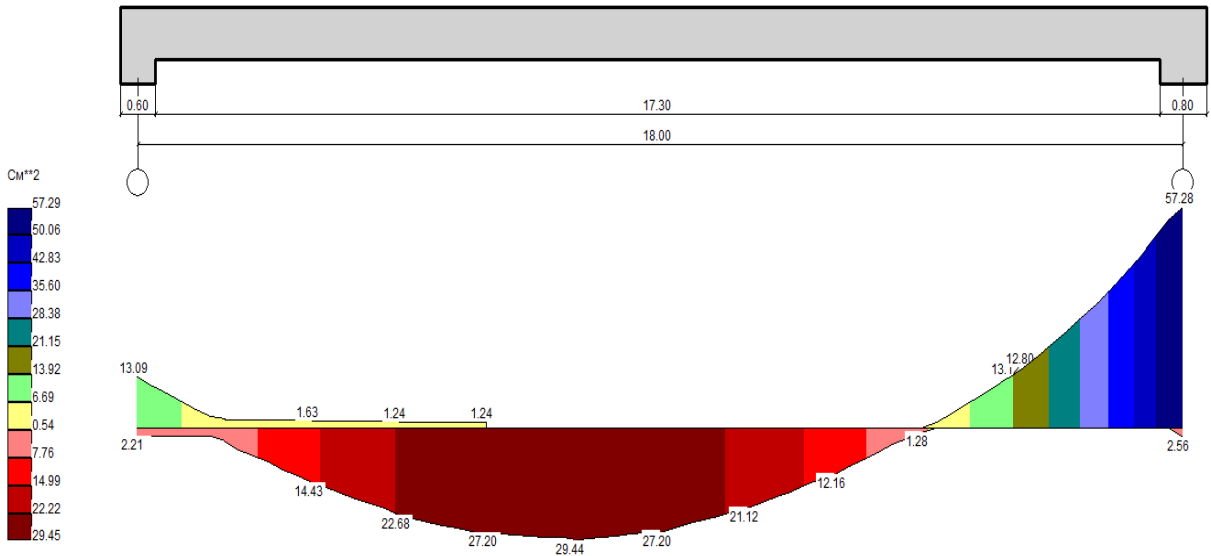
Балка Б11. Епюра розрахункового поздовжнього армування.
